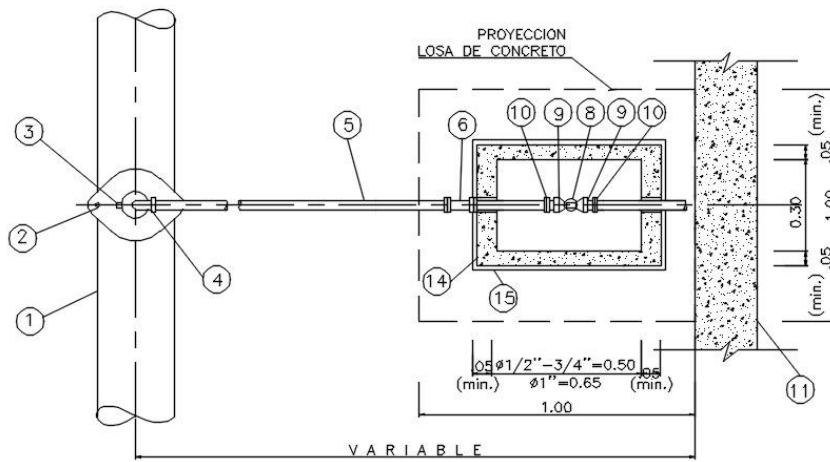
Detalles vista de planta de la Línea de Aducción y Red de Distribución (CAD)
